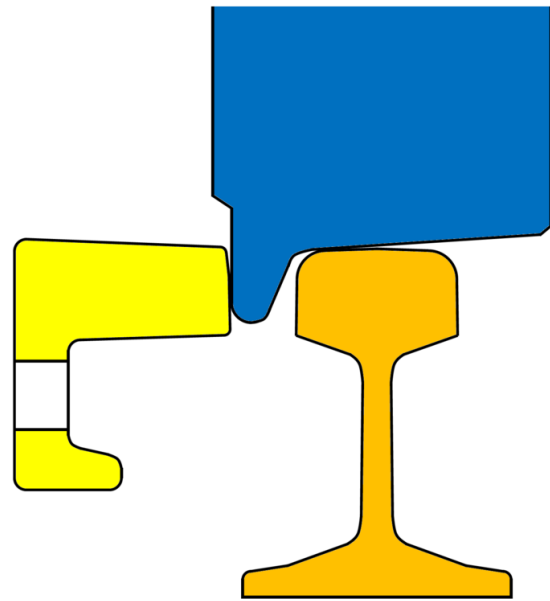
Controrotaia della linea di Trogen, senza sopraelevazione rispetto al piano del ferro
